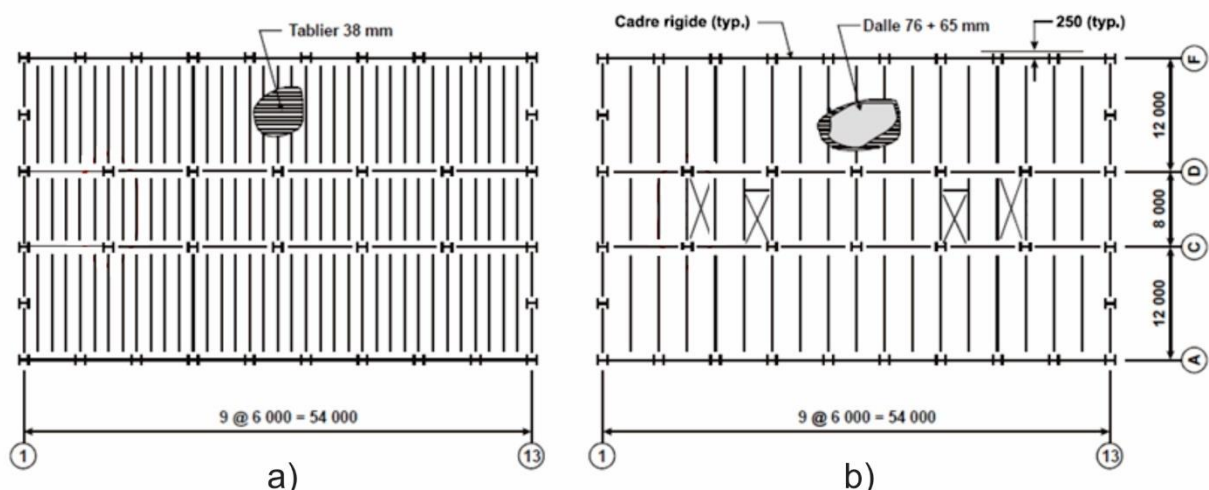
Dimensions en plan du bâtiment à l'étude : a) toit b) étages. Adapté de Tremblay (2017b).
